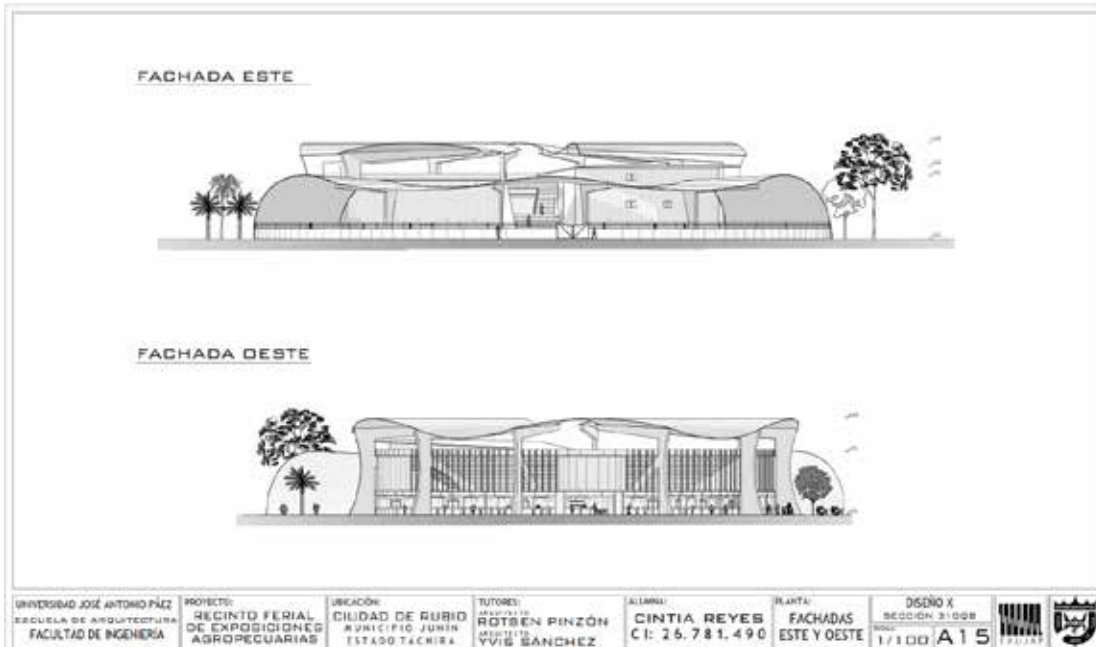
Plano A15, Fachadas este y oeste. La Autora (2020).
